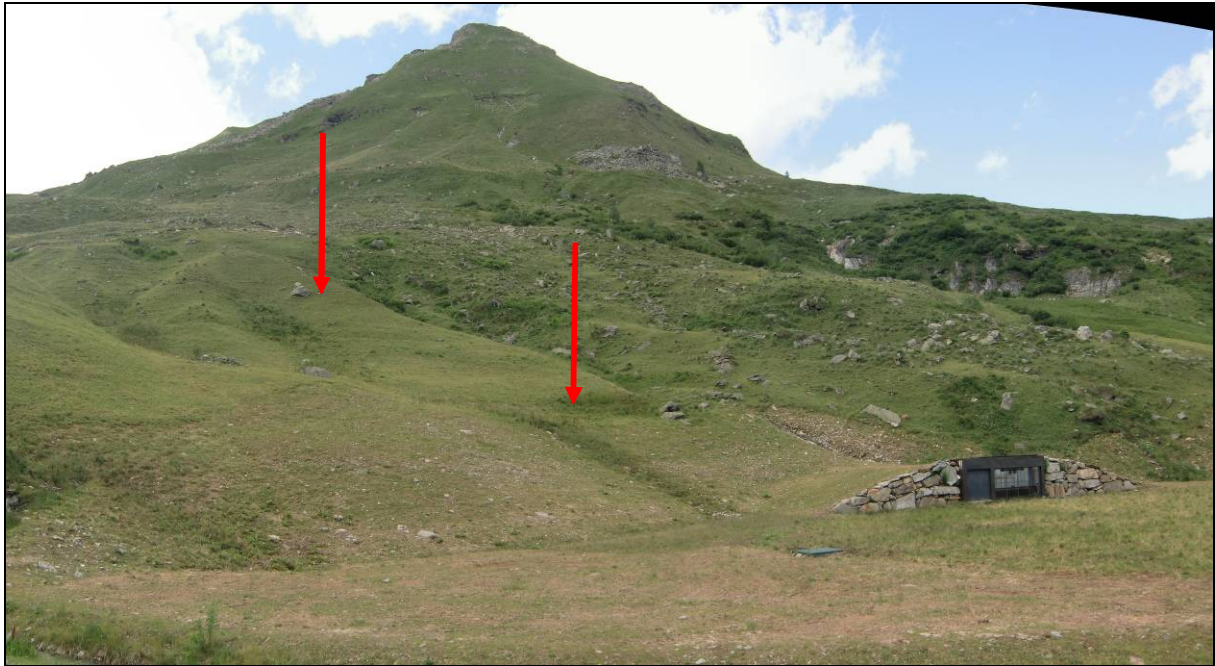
/2 - Vista dell'area della pista Mullero 2 dalla Grande Halte
